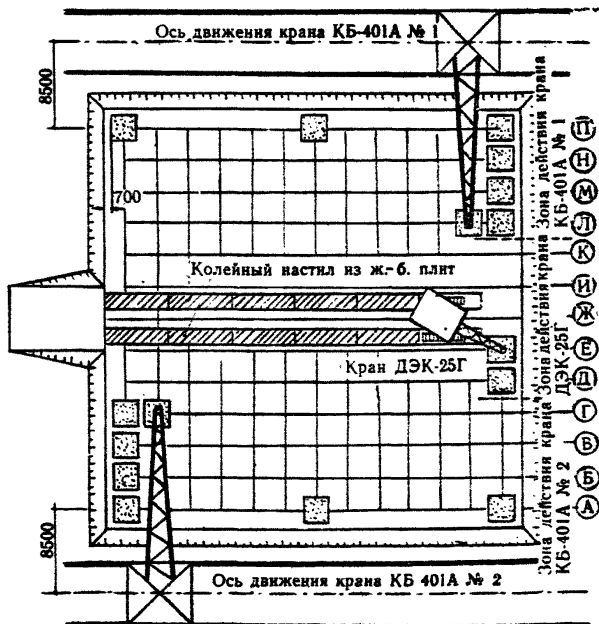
Монтаж фундаментов силосного корпуса СКС 3х144
